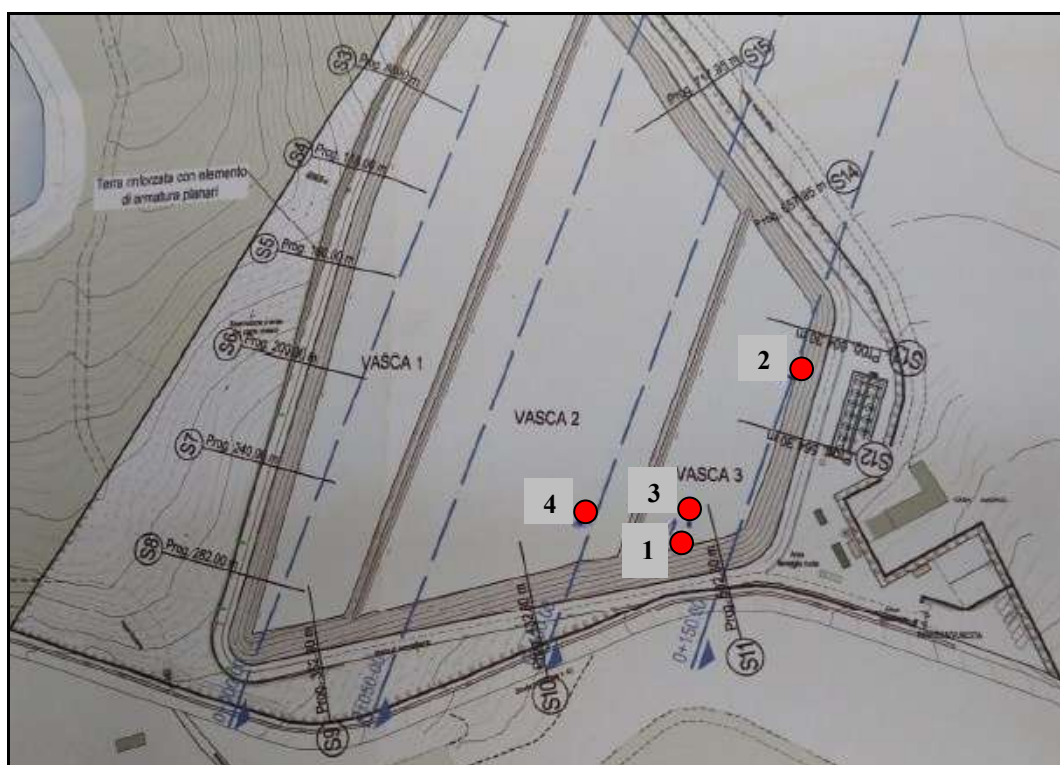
localizzazione dei campioni prelevati tramite infissione di fustelle metalliche
